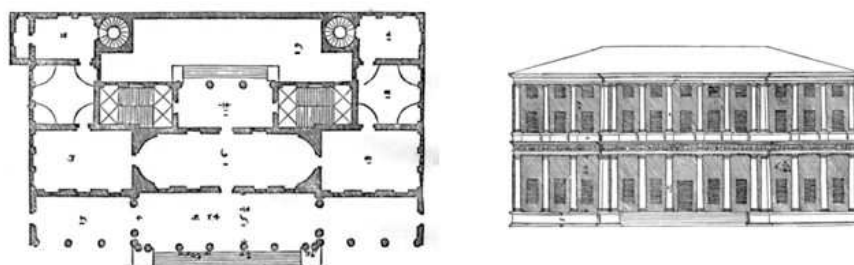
Palazzo Chiericati, planta e alzado. (Palladio, 1570, p. 6)
